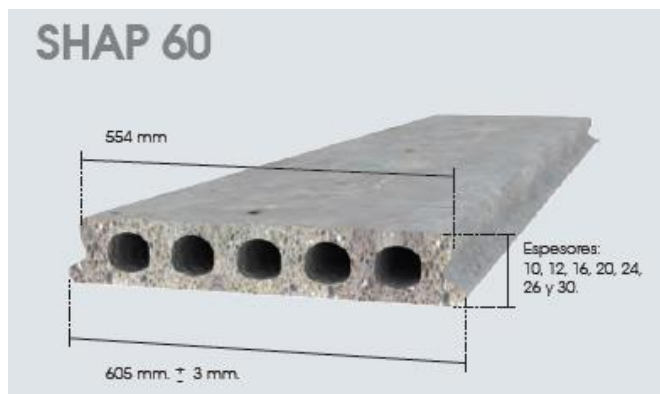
Losas huecas de hormigón pretensado SHAP 60 para tribunas
